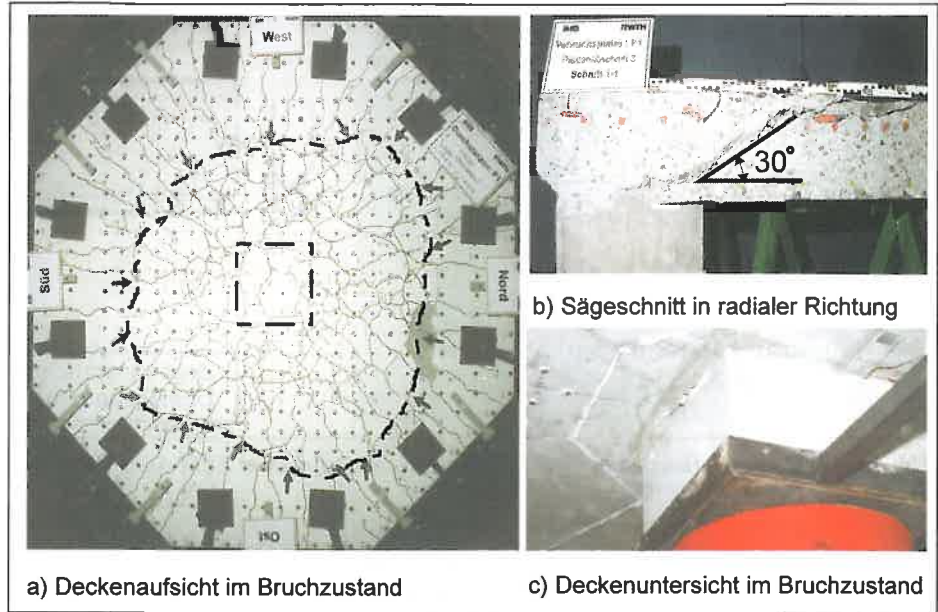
Durchstanzversagen des Versuchskörpers P1 ohne Schubbewehrung [8]
